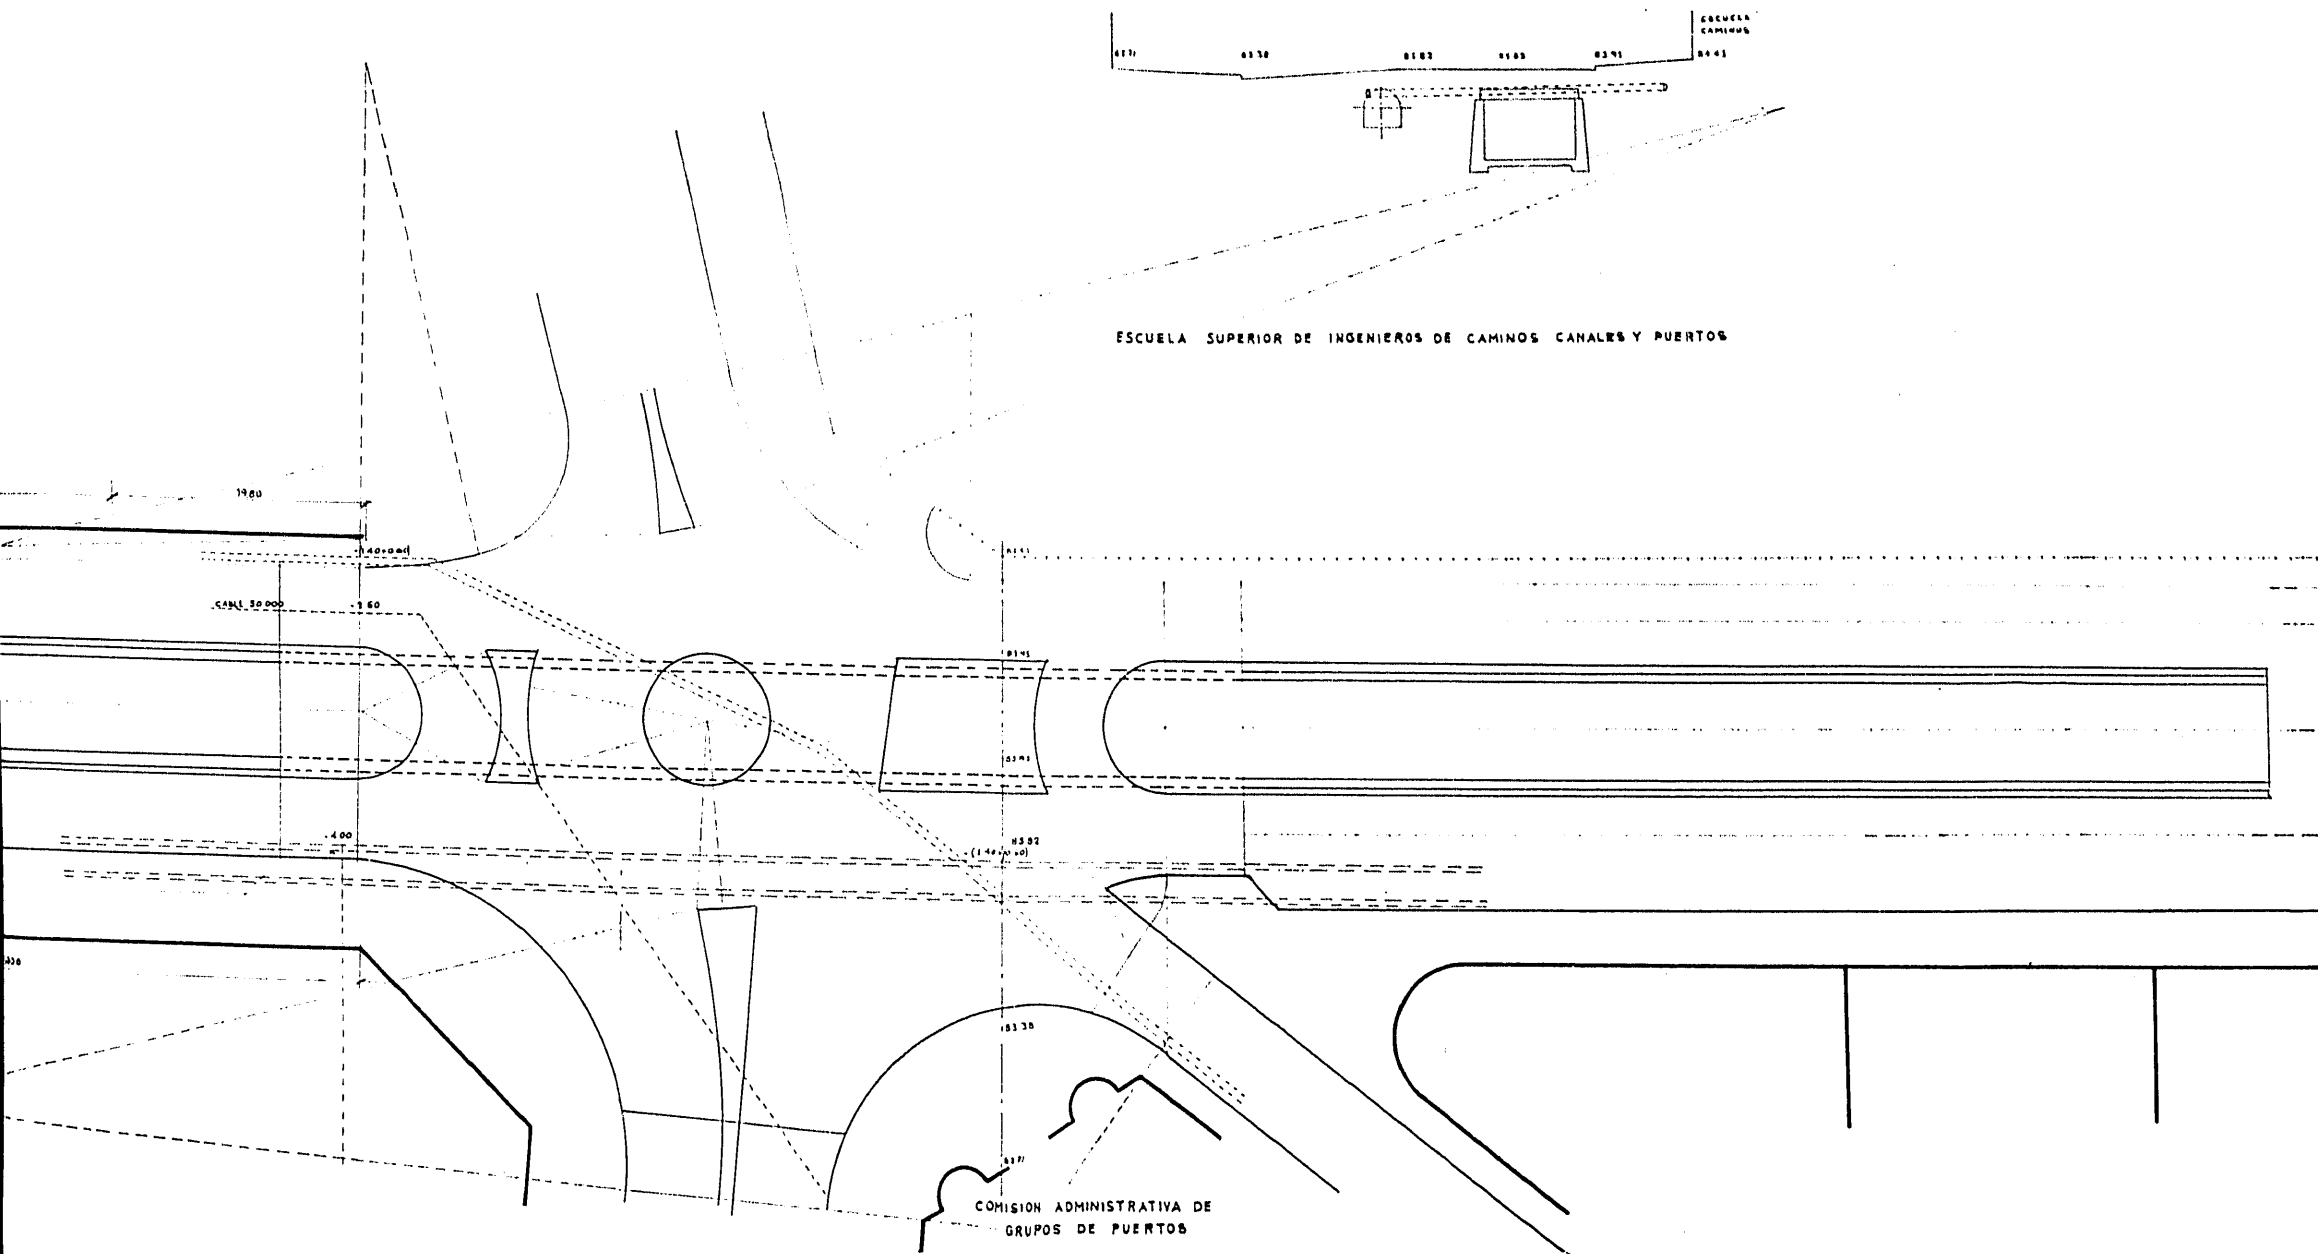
Planta del paso subterráneo en la calle Alfonso XII.
